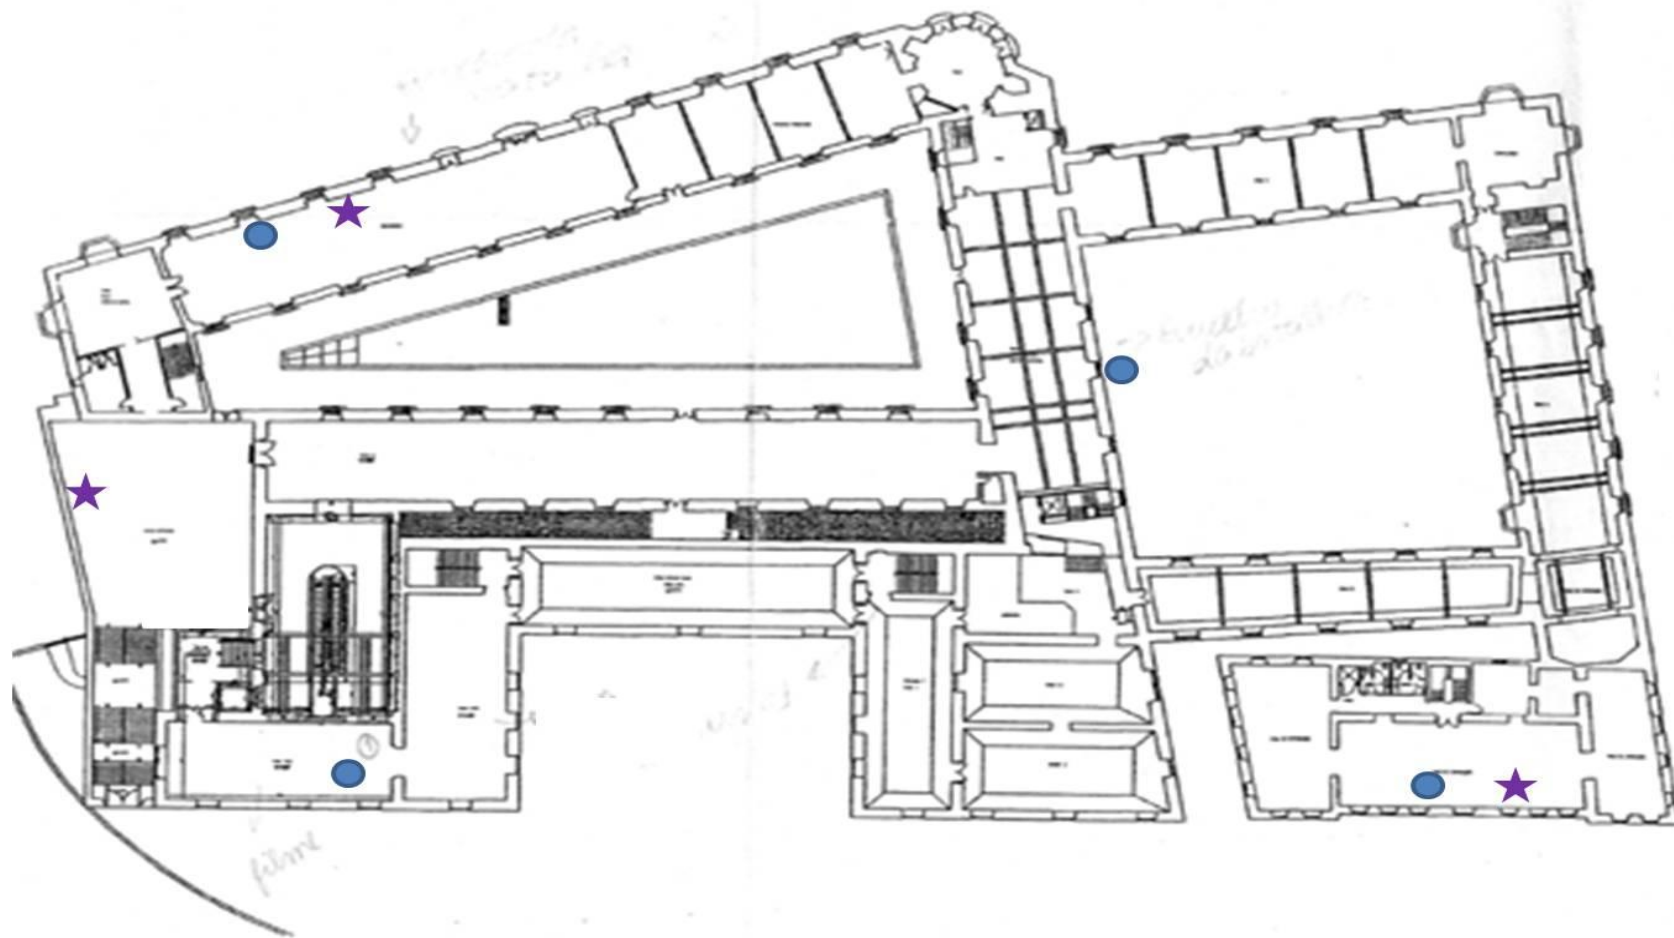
Planta baixa, Prédio C, primeiro pavimento
